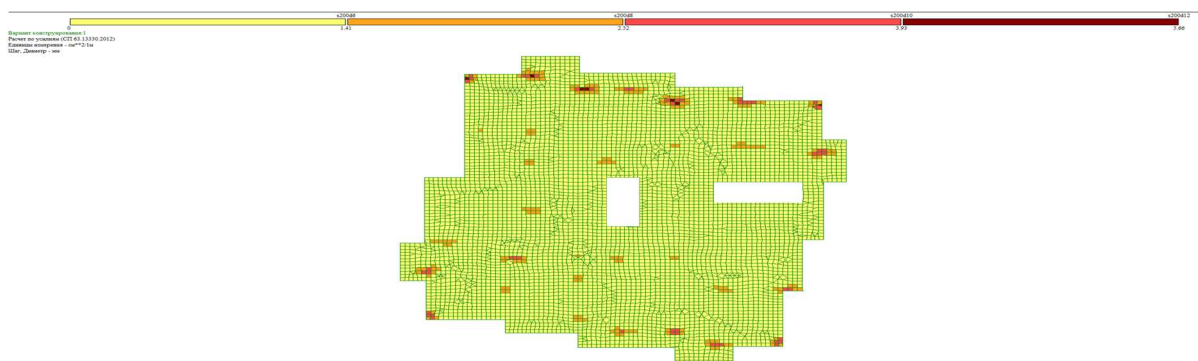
Верхнее армирование перекрытия этажа по оси Y
